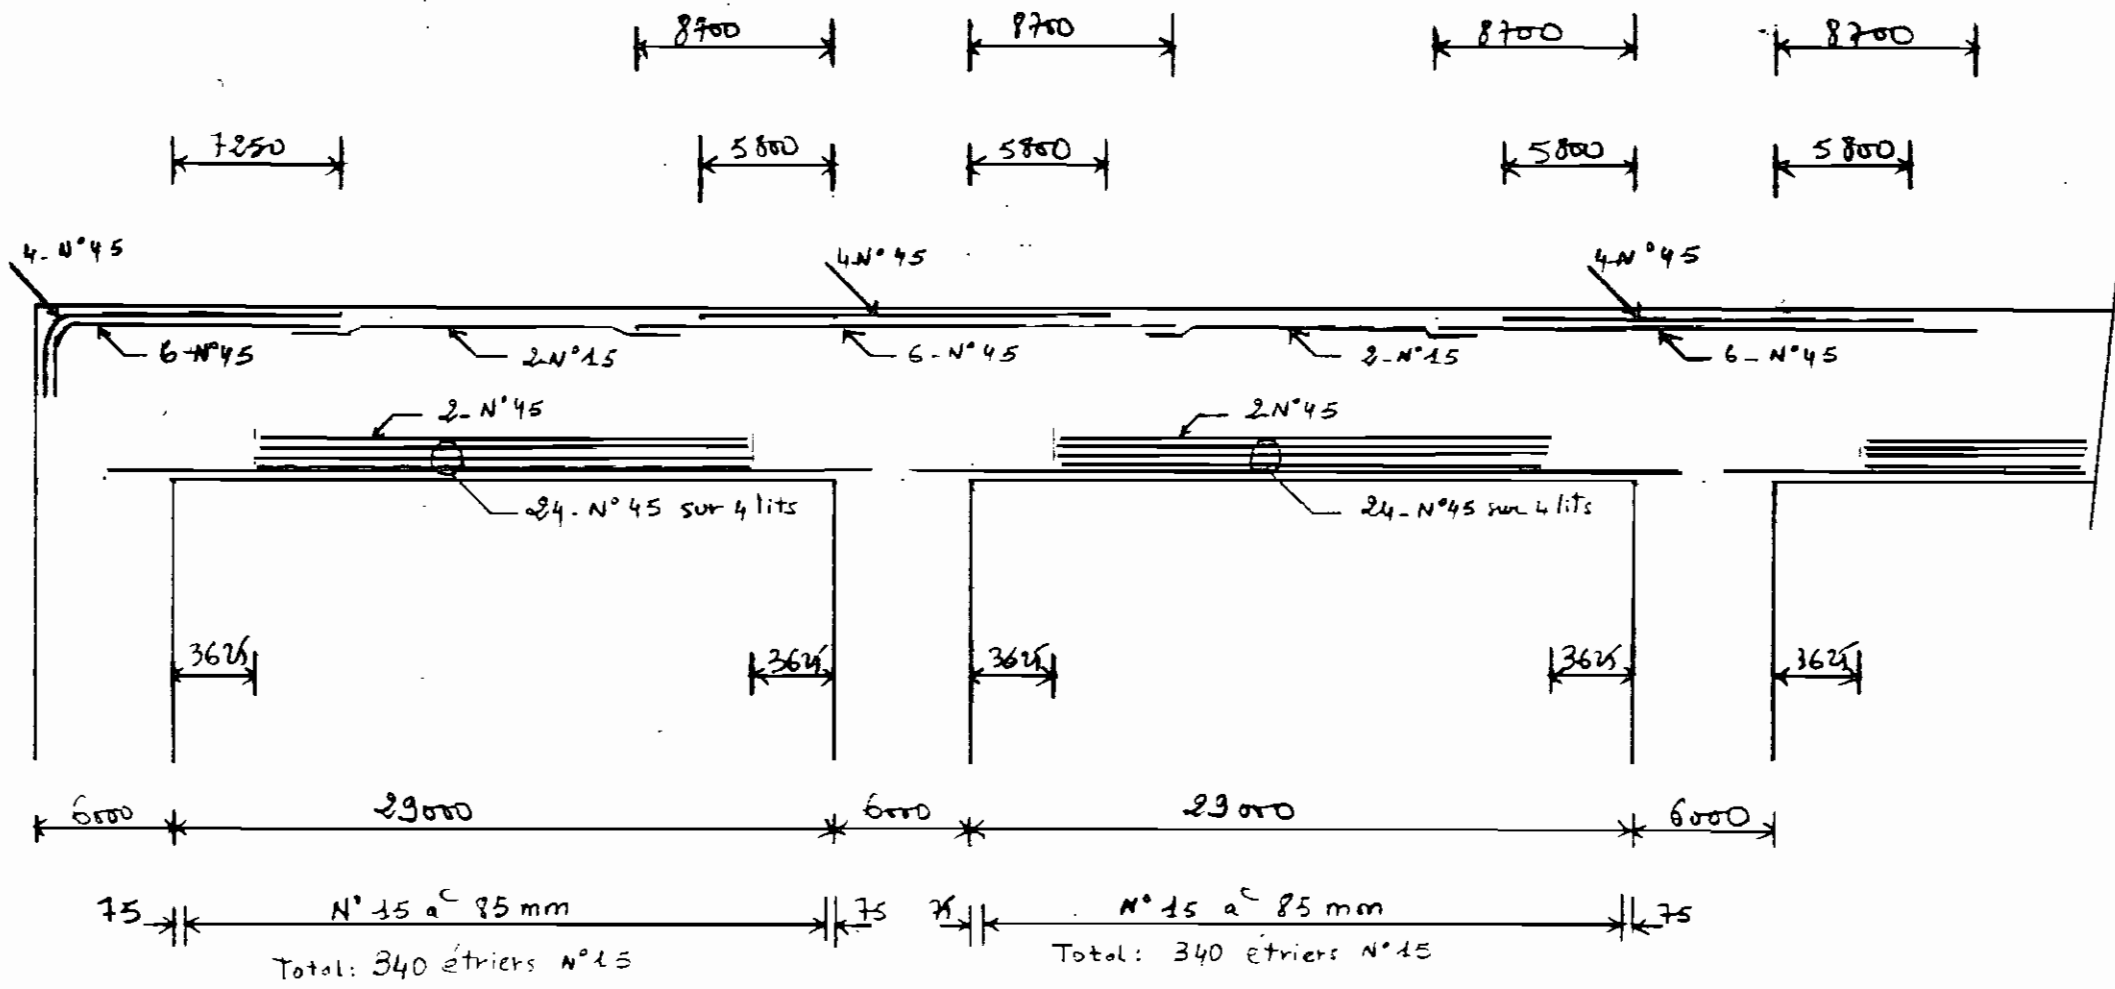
Schéma de ferrailage de la poutre principale centrale.
